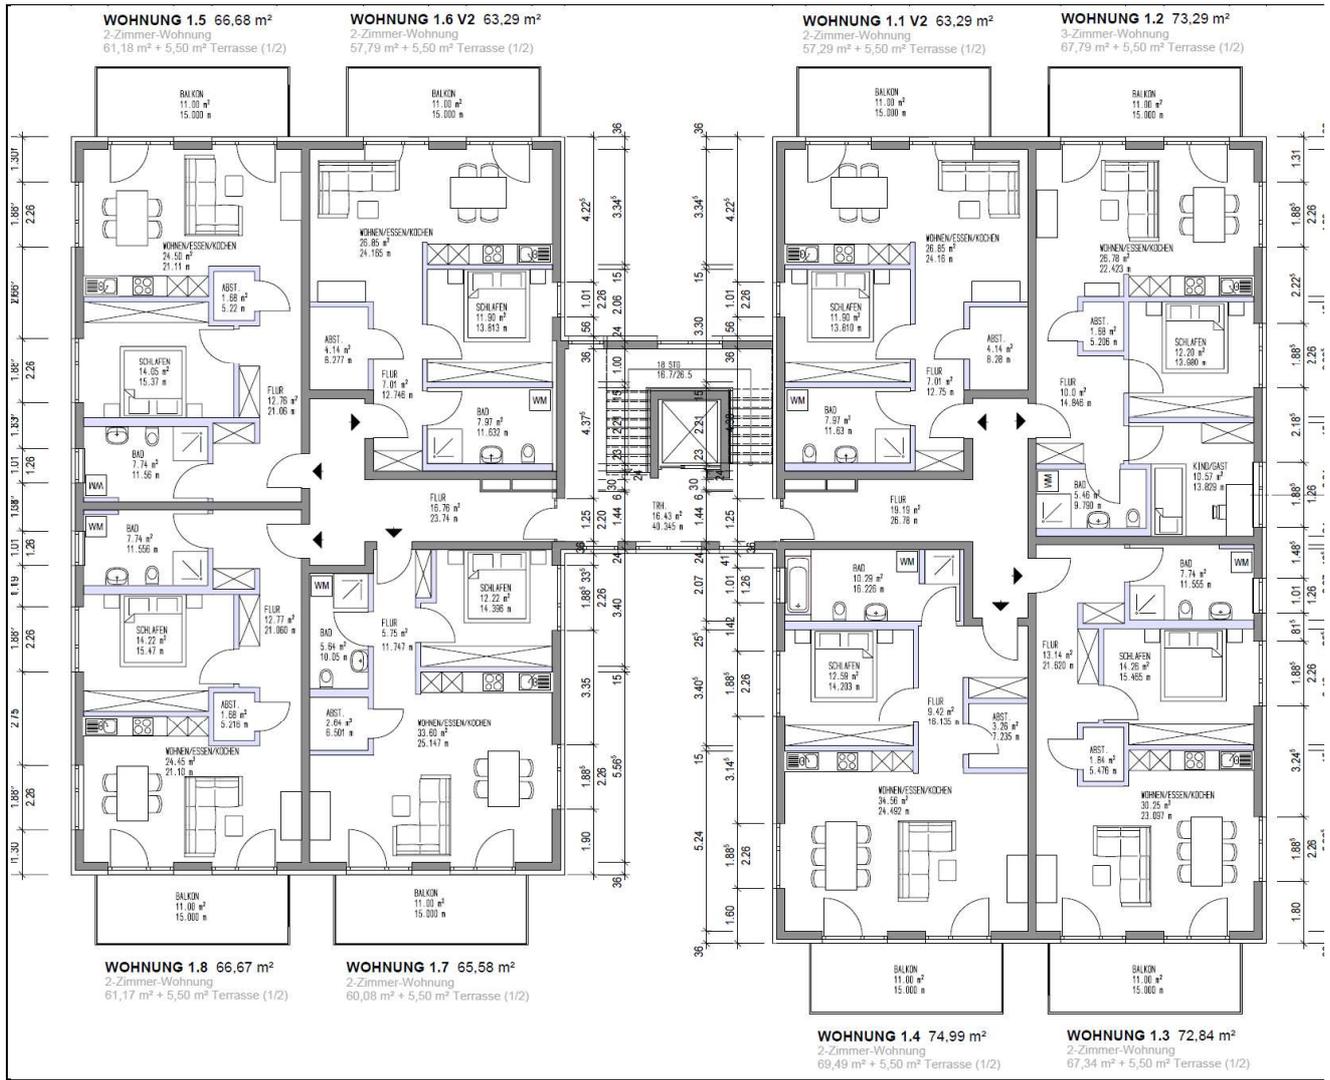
Grundriss Geschoss 1-4.
